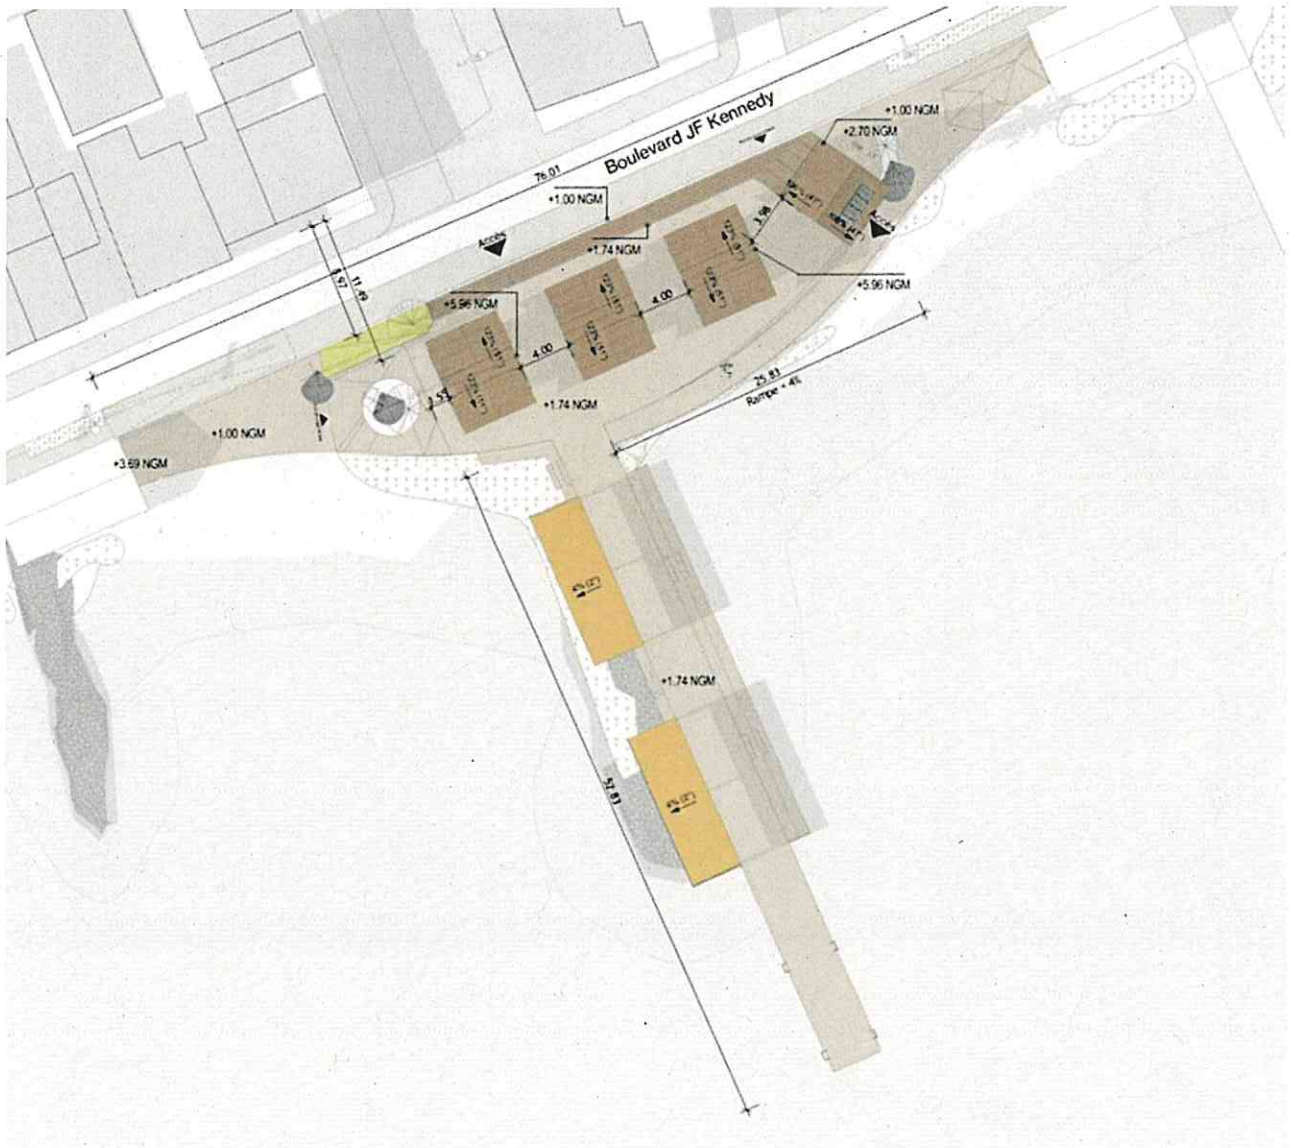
PLAN MASSE - MARCHÉ DE FRUITS ET LÉGUMES
